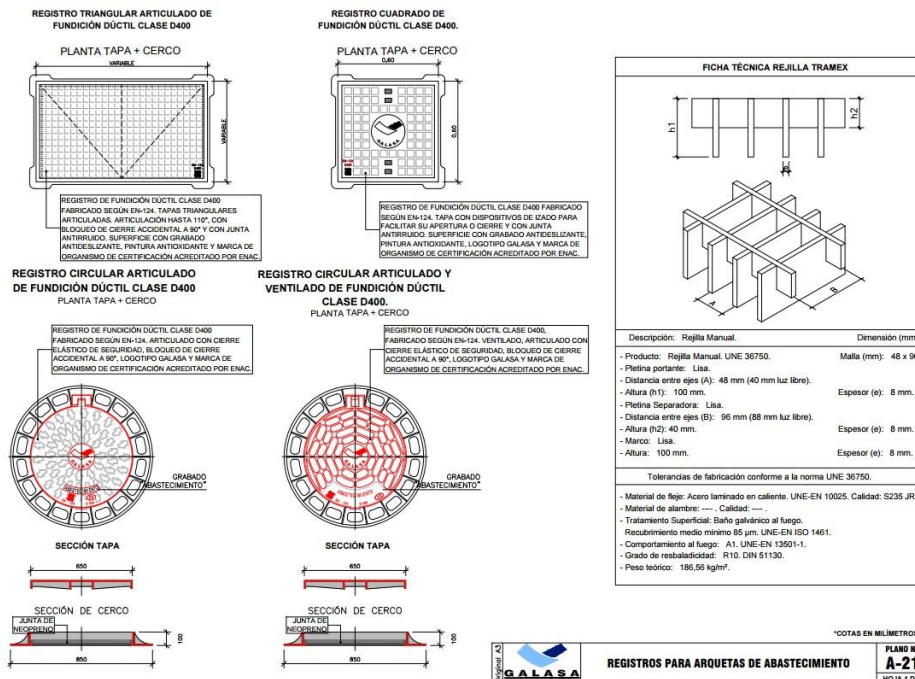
Detalle Constructivo. Arquetas para aloj. de valv., ventosa y/o accesorios. Fuente: Galasa
